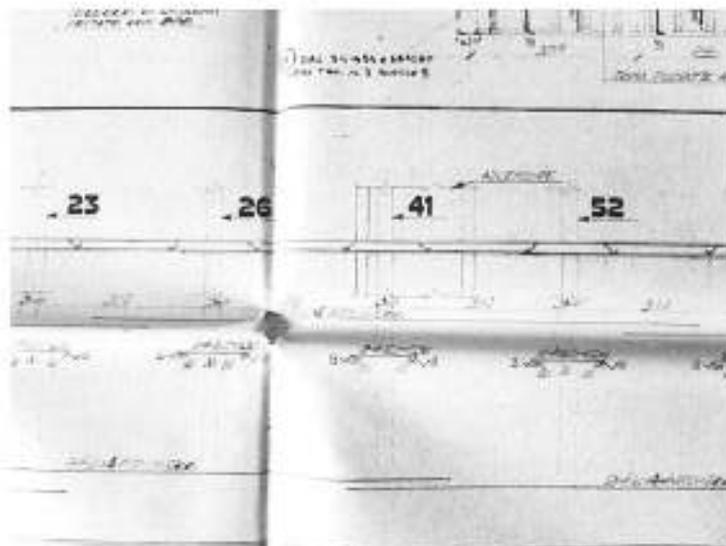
TAV. 3 – prospetto armatura trave T6 (particolare intorno al vano ascensore) – è rimasto segnato la pilastrata n. 41 (probabilmente trattasi di un refuso)
